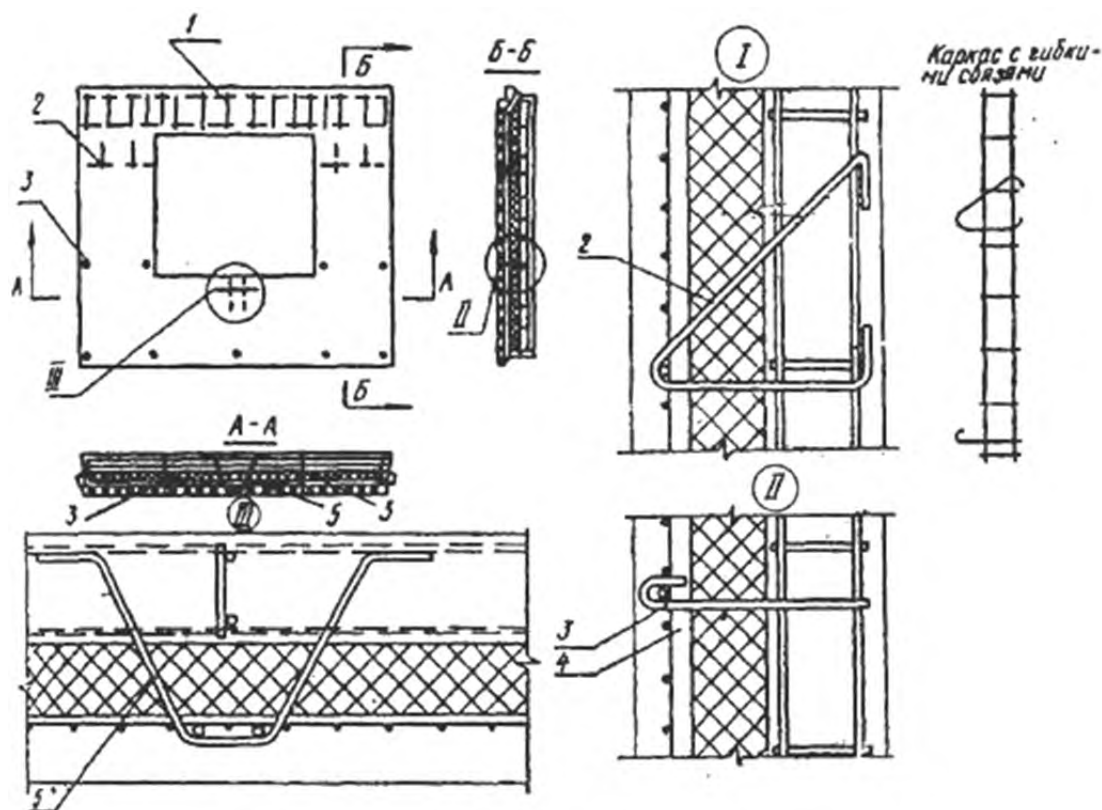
Схема армирования трехслойной панели с гибкими связями из отдельных стержней:
